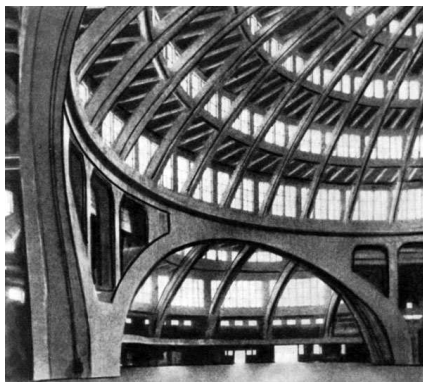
Металлические и железобетонные конструкции в общественных зданиях:
